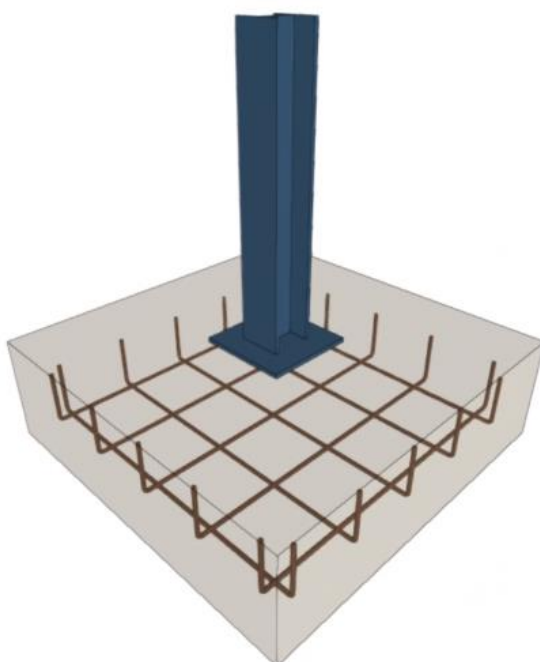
Cimentación de pilar: placa de anclaje y zapata
